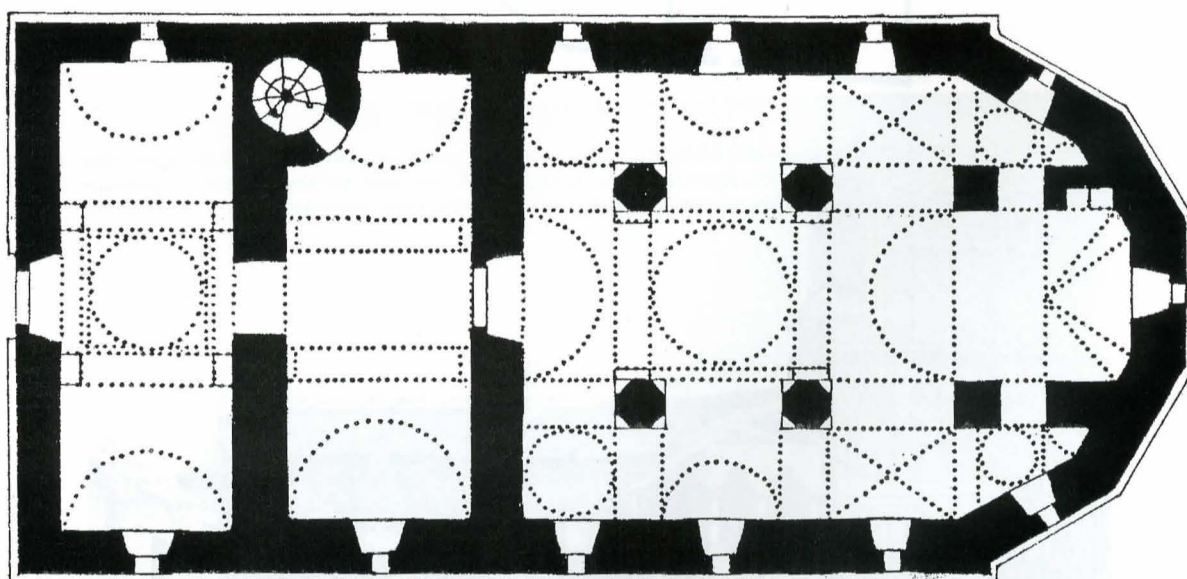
Biserica domnească din Câmpulung în a doua fază de construcție (1635–1636), plan și secție restituite
